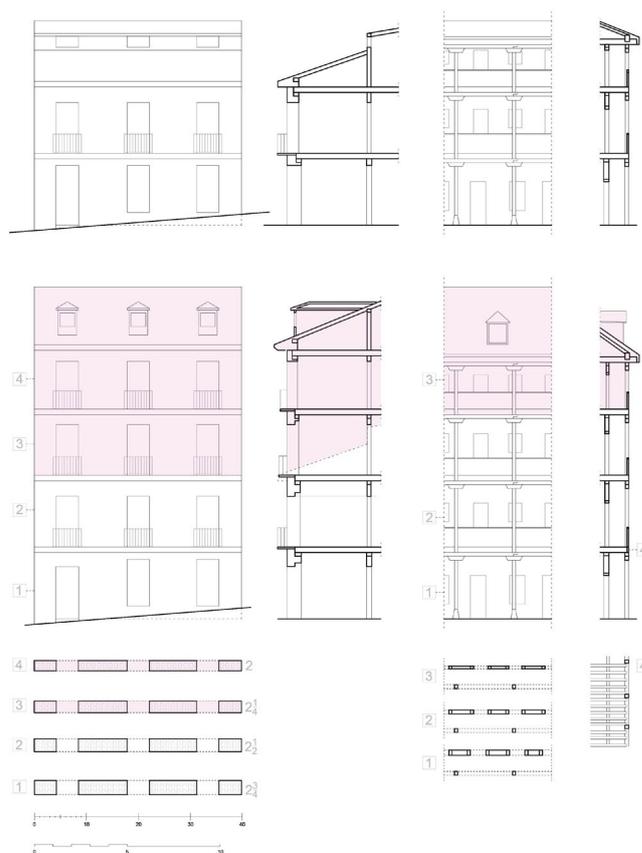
Embajadores 46, de [2+s] a [4/4]; fachada de albañilería y muros de carga interiores y patios entramados de madera (Autor y colaboradores, 2021).
